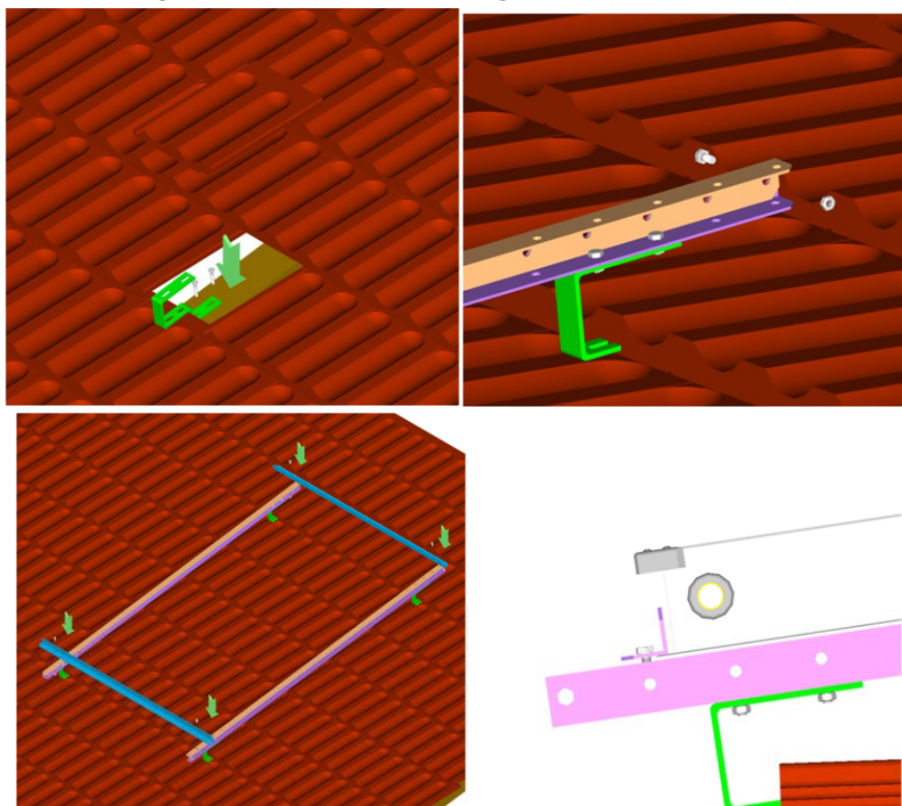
Mise en place sur toiture inclinée (identique pour 1, 2 ou 3 capteurs)
